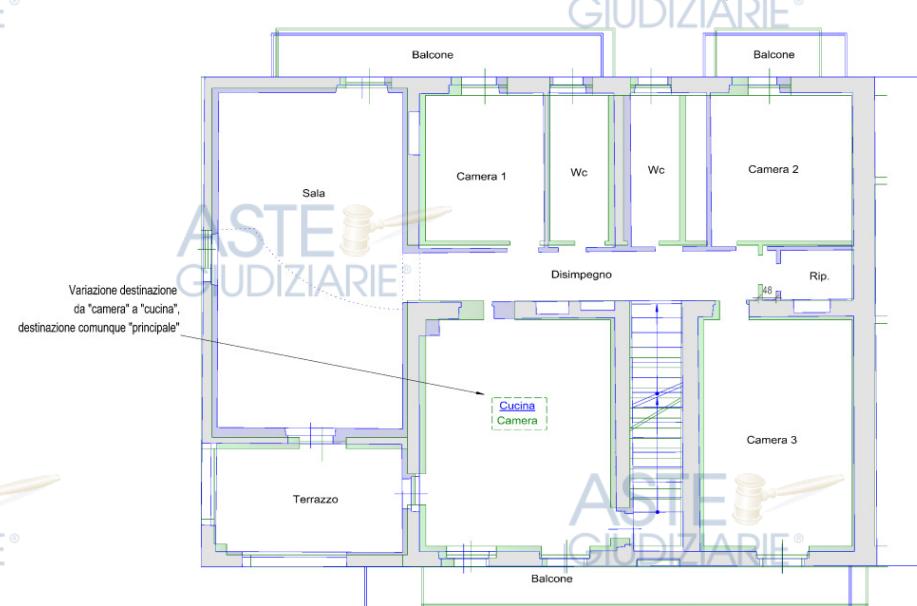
Estratto Tavola di Confronto fra rilievo stato di fatto e tavola di Conc. Sanatoria 1517/86 – Pianta piano primo
